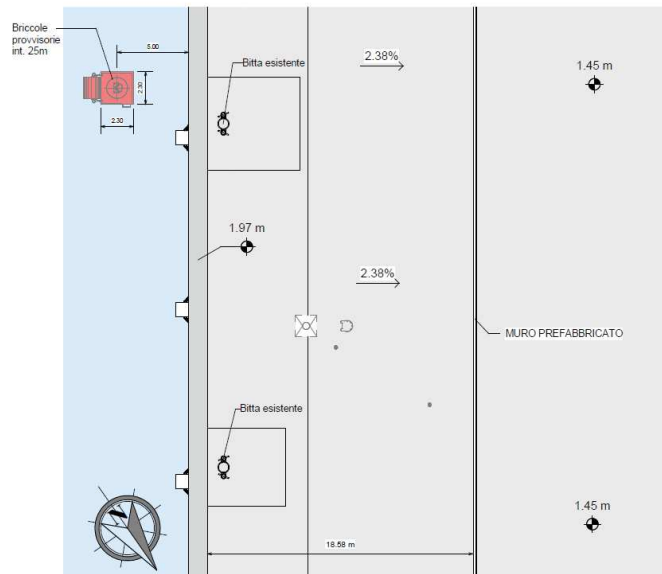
Planimetria con indicazione delle briccole provvisorie da installare.
